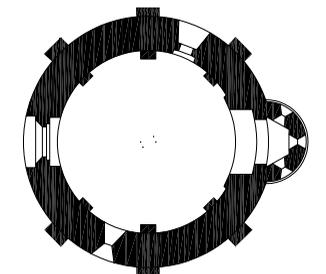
Grundriss St. Stefan bei Niedertrixen, M 1:200, Planarchiv des BDA Wien, 1885.
